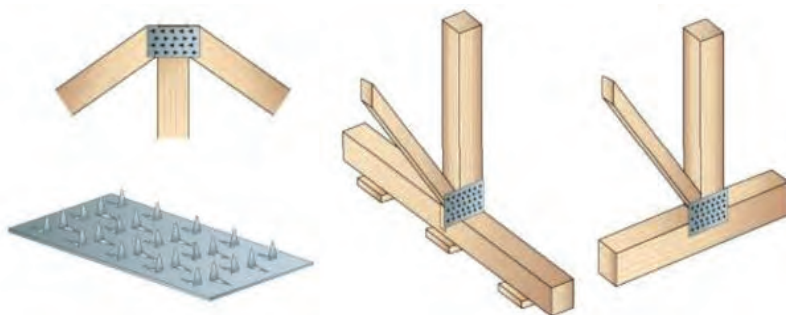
Схема соединения деревянных конструкций металлическими зубчатыми пластинами
